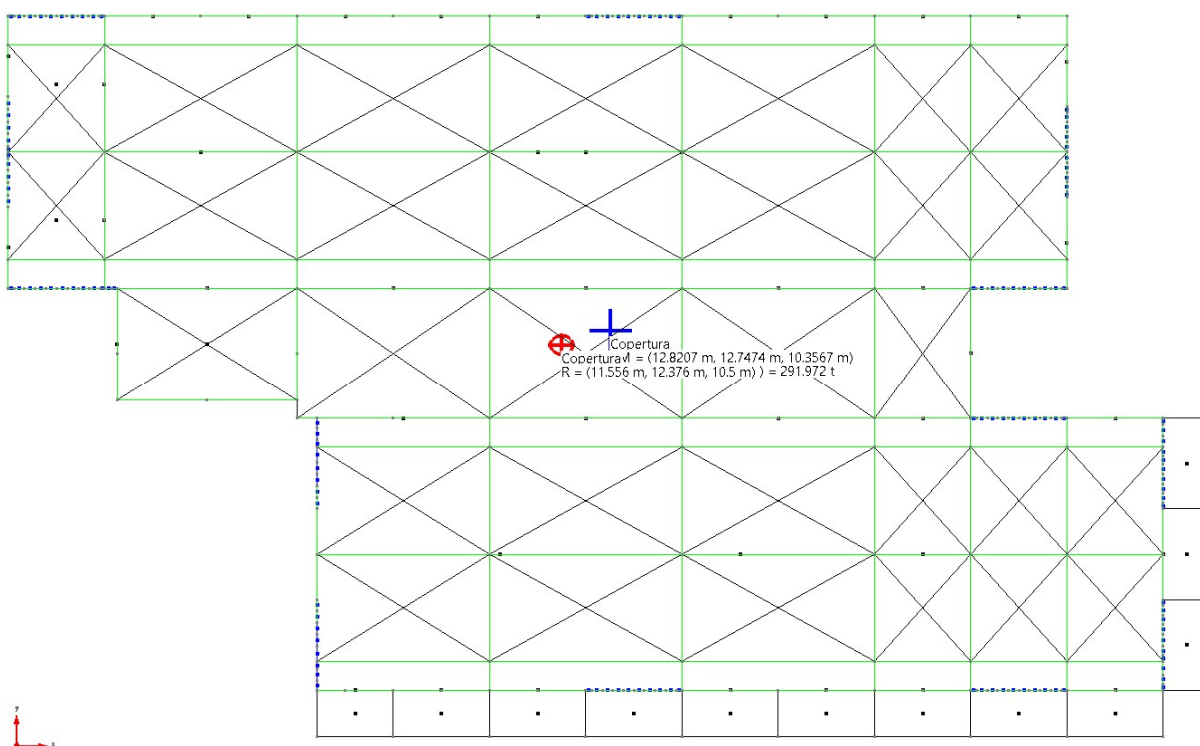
Stato di Progetto : posizione del baricentro delle masse G e delle rigidezze R in copertura.
